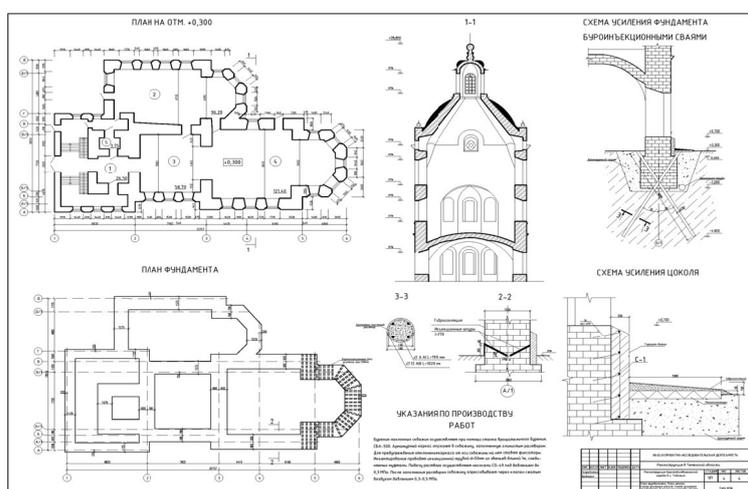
Предложения по реконструкции Крестовоздвиженской церкви
